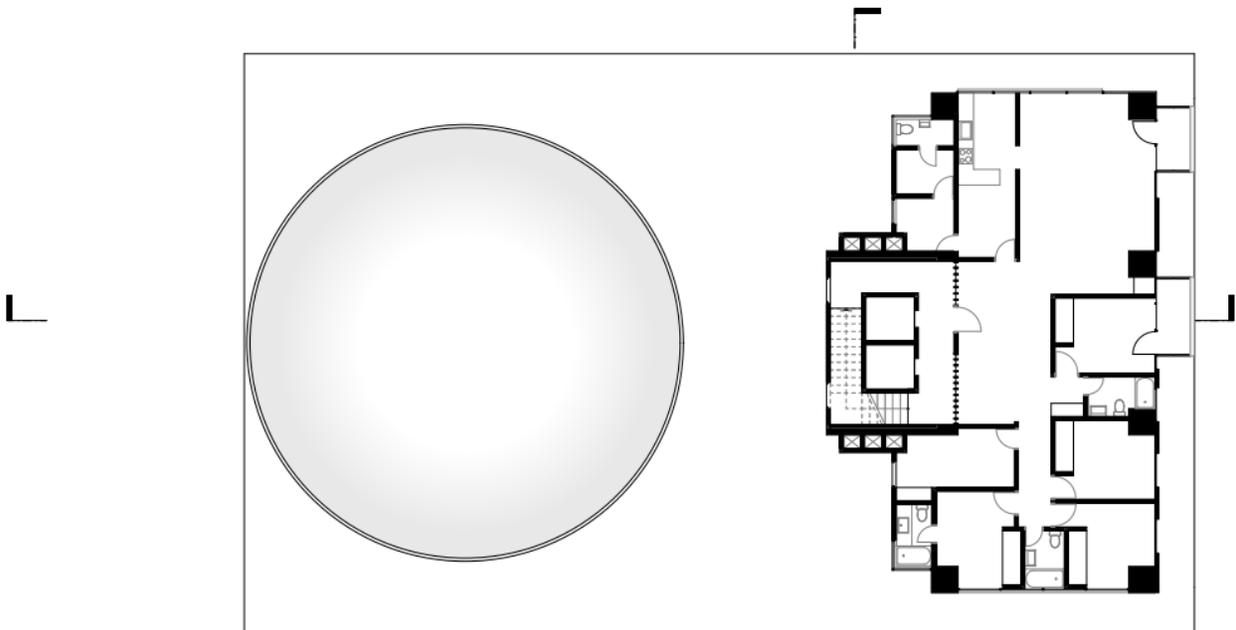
Planta alta original N+15.50. Fuente: Tesistas.
